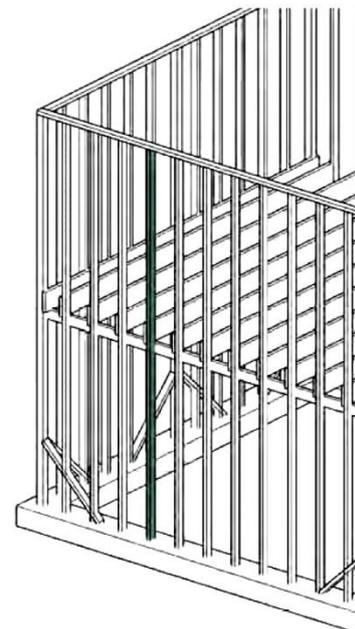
Entramados ligeros: esquema sistema "balloon frame"
